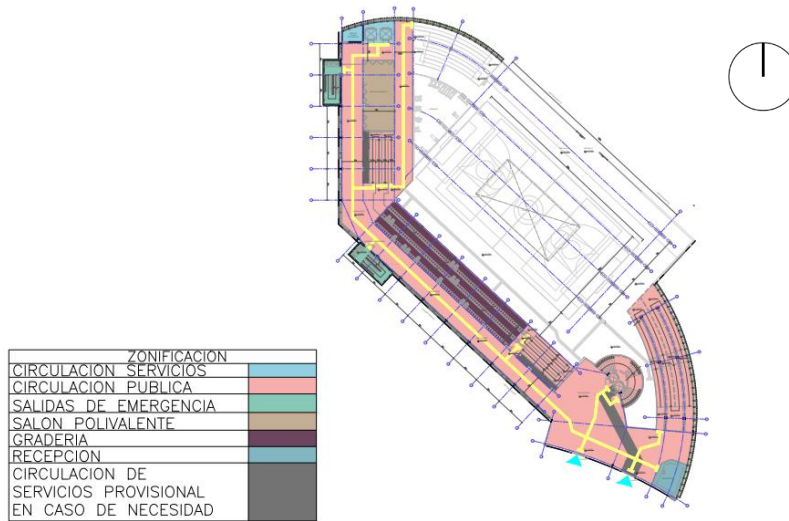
Planta primer piso Centro Deportivo y Recreativo Fontana
